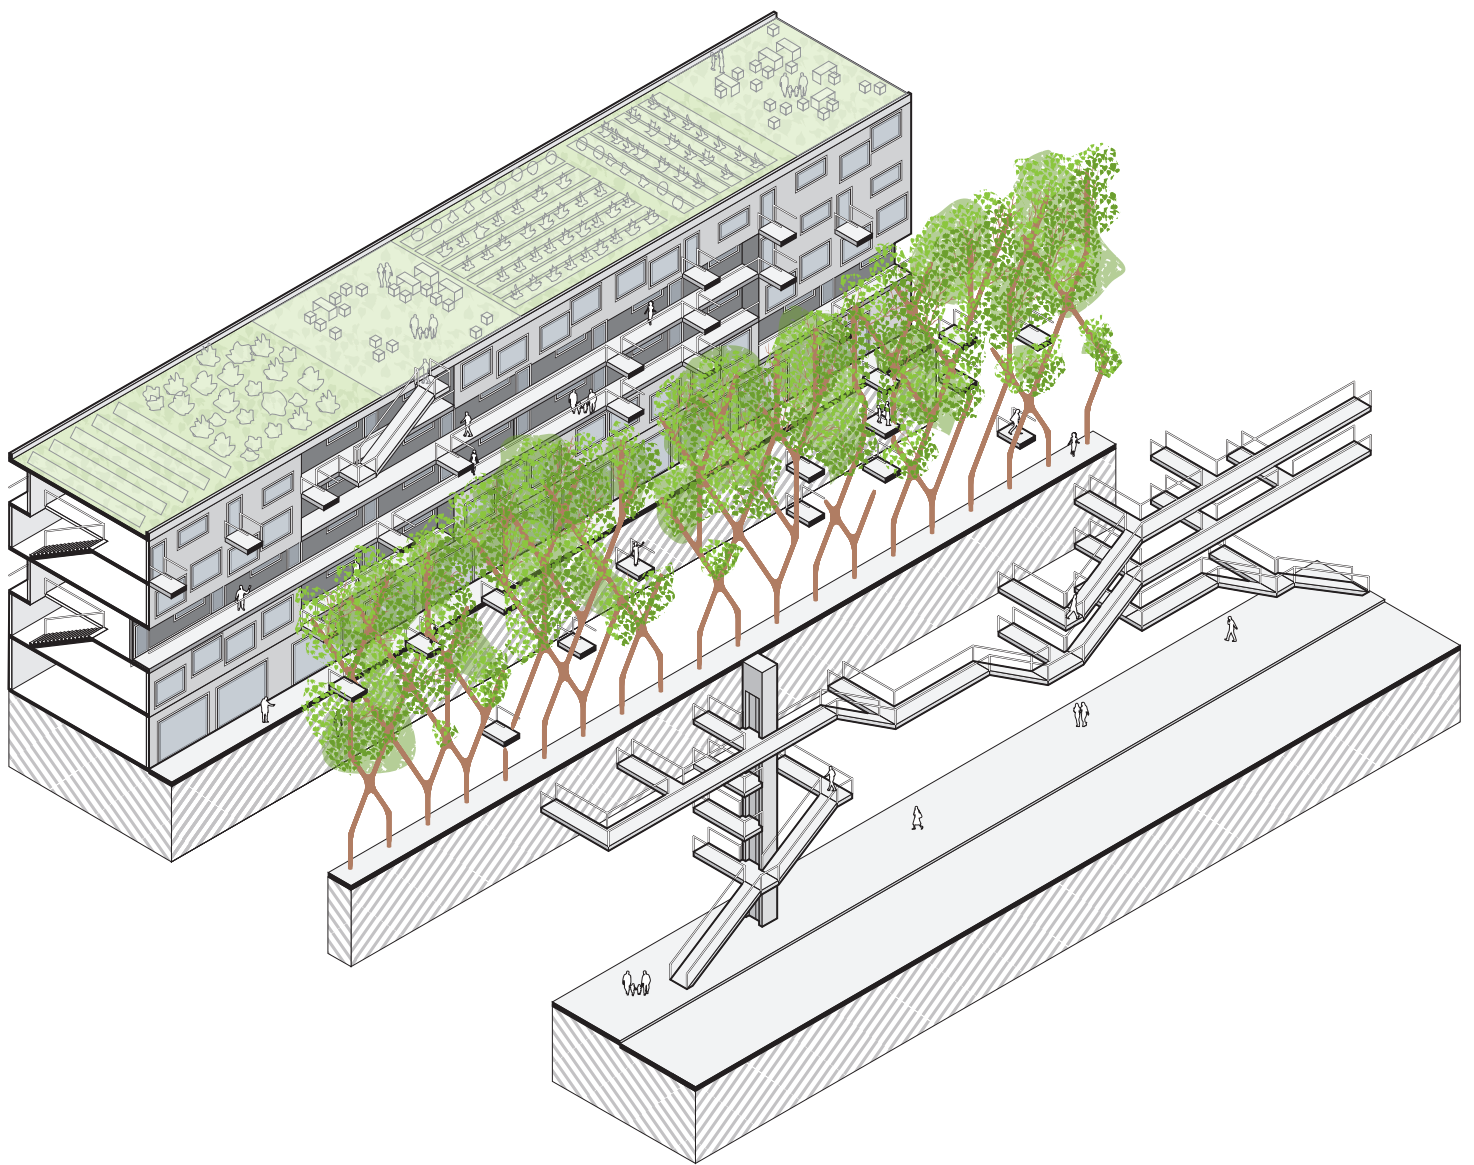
Explosionszeichnung Laubengangtypologie: Bauwerk - Baubotanik - Laubengang
